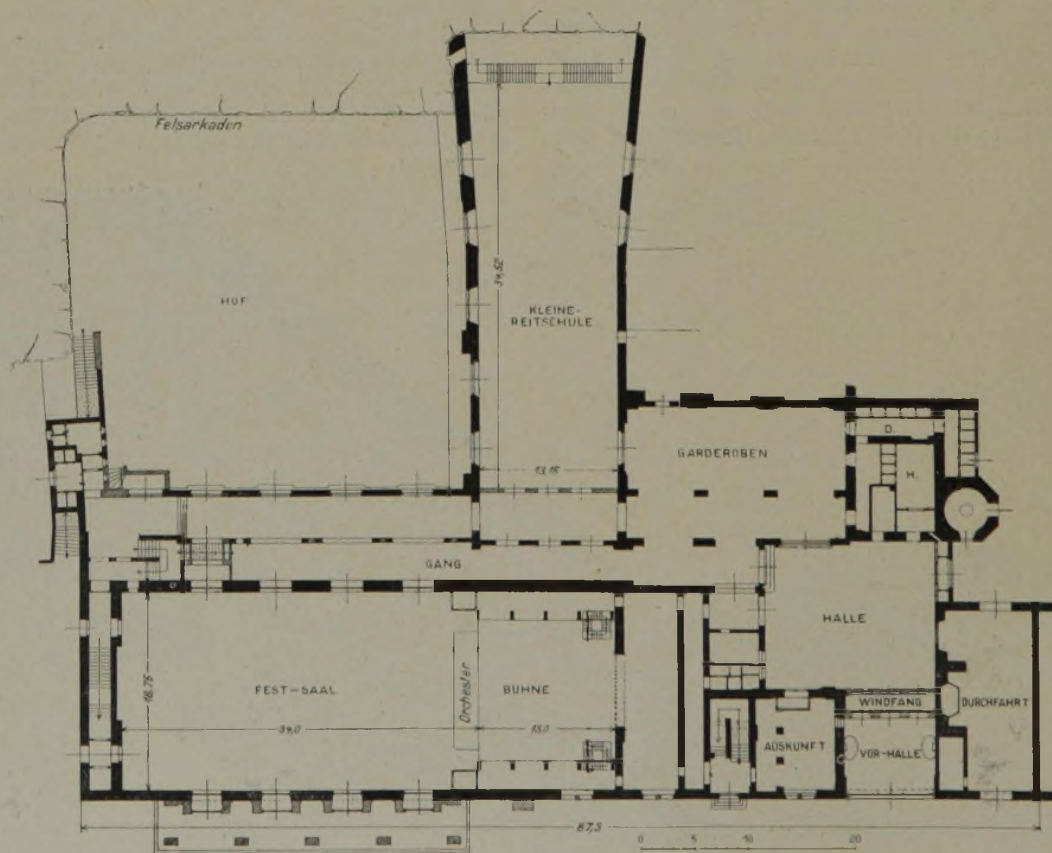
Festspielhaus Salzburg. Grundriß des Erdgeschosses. (1 : 700.)
